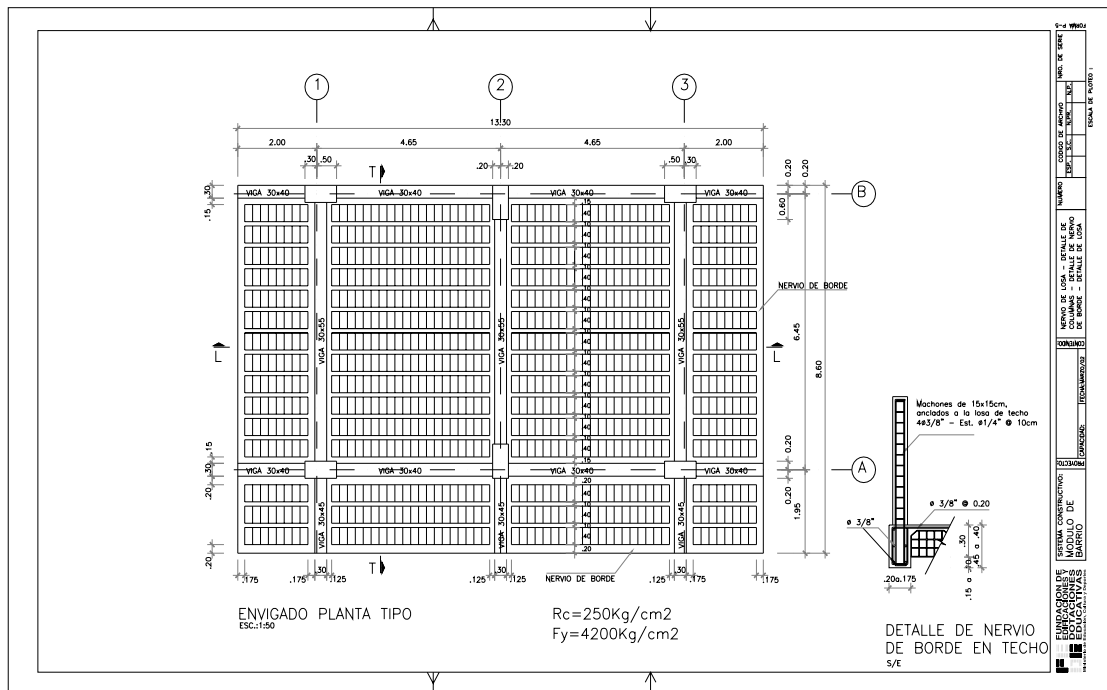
Engigado planta tipo / Detalle de nervio de borde. Modulo de Barrio.
